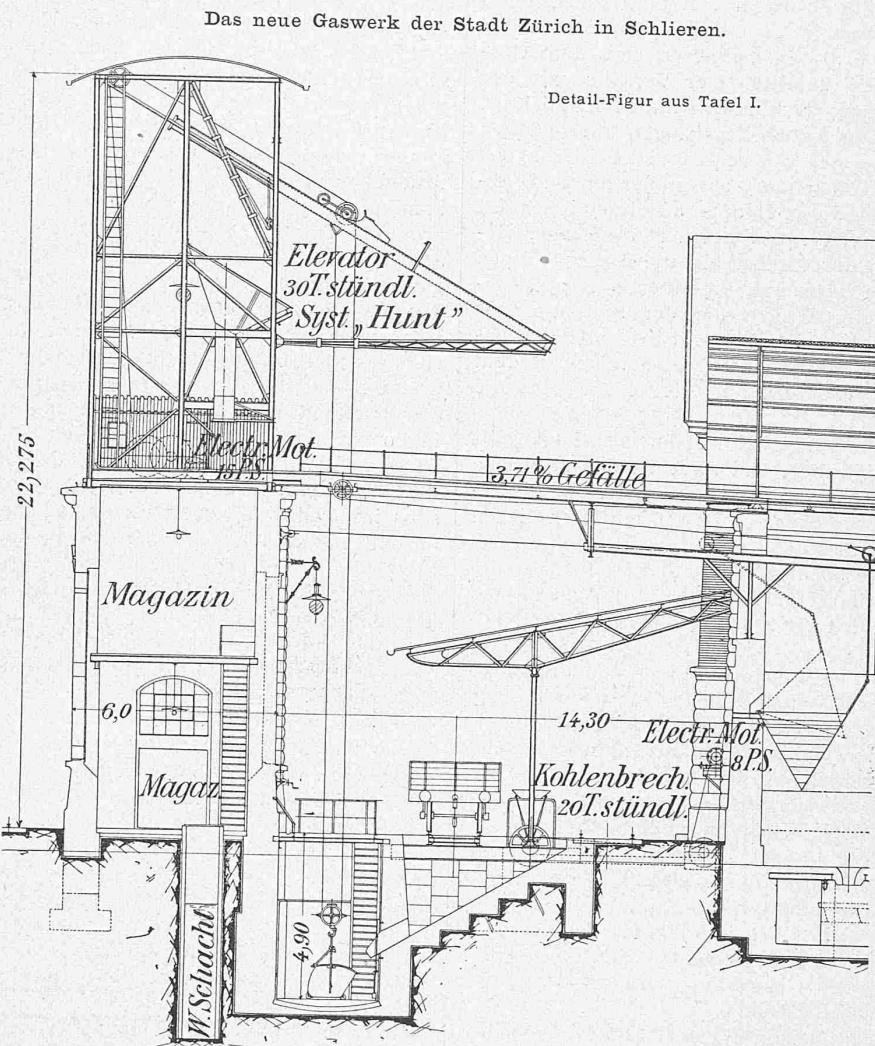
Querschnitt durch das Elevatoren-Gebäude mit Füllrumpf-Anlage 1:200.
